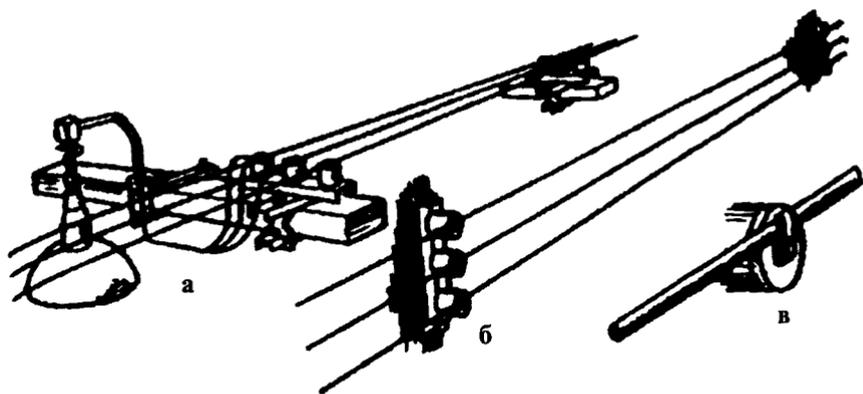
Примеры выполнения электропроводки на изоляторах:
